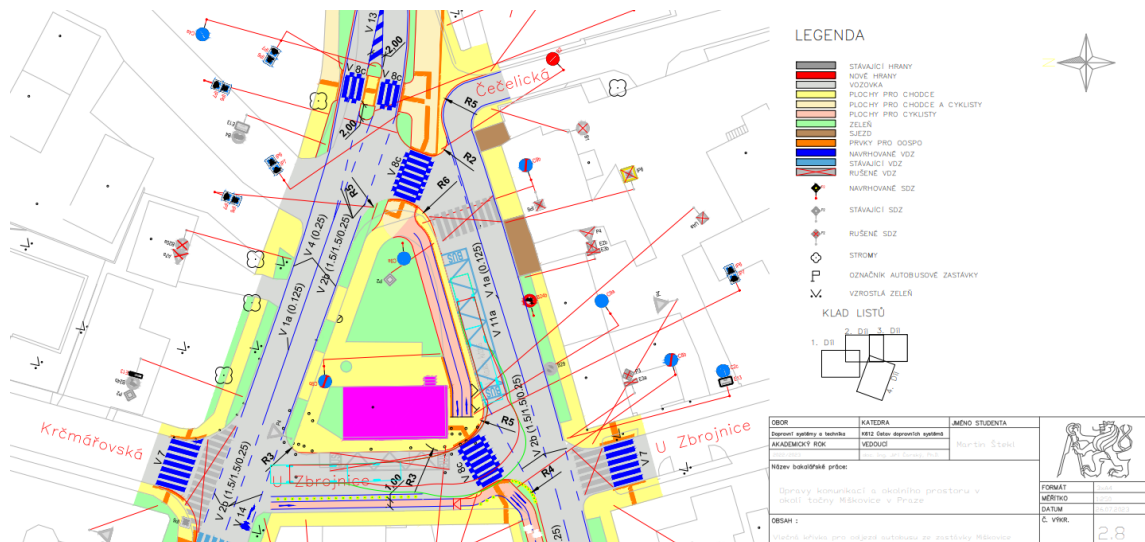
Navrhovaný stav v detailu, příloha 2.5 (zdroj: autor)
